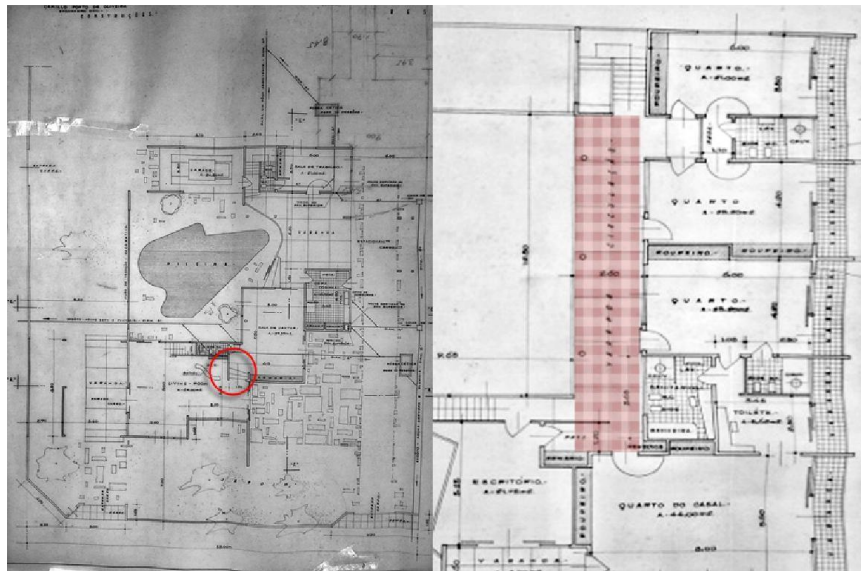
Plantas baixas da Casa Jean Bittar (1956). À esquerda, pavimento térreo; à direita, superior. Destaque do *split level* (círculo) e da circulação linear (hachura).
